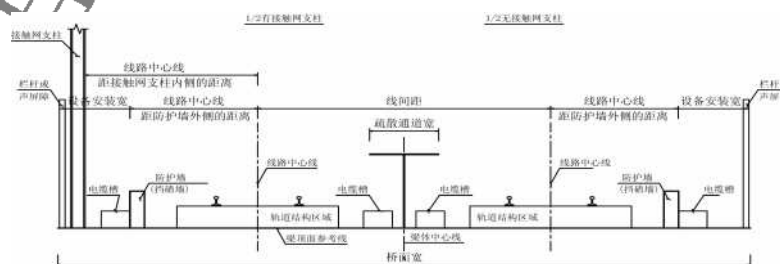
双线桥面布置示意图(二)(疏散通道位于中间)
